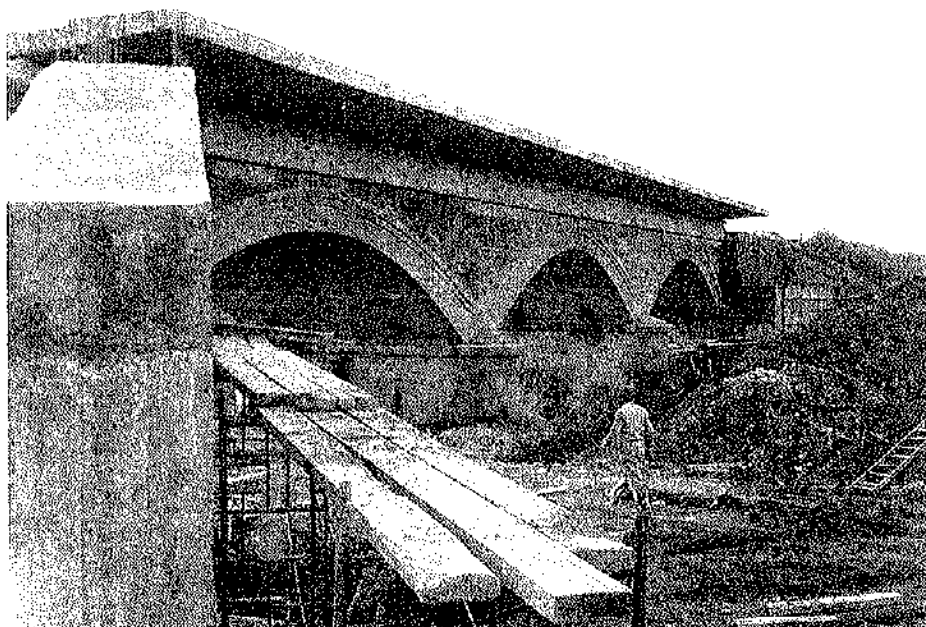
Ampliación de la plataforma de un puente antiguo con losas prefabricadas de hormigón armado.
